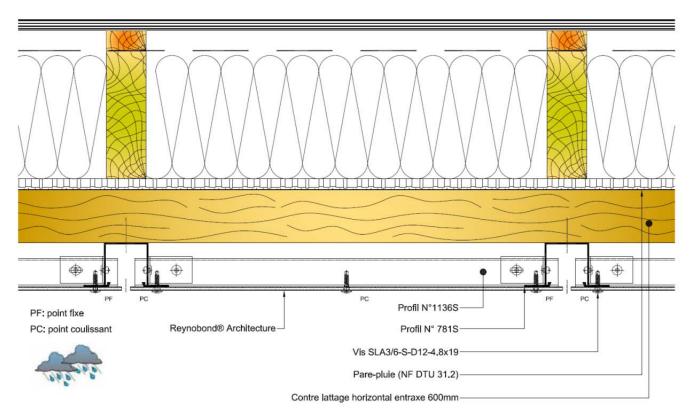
is – Joint vertical - Coupe horizontale – Système vissé SC 50 4c – Pose sur COB
